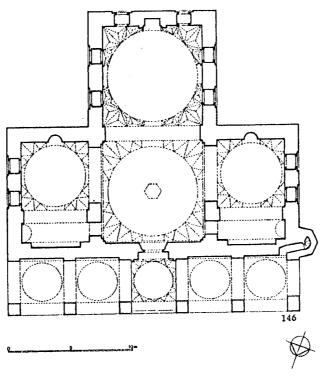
مسقط أفقي للجامع الاخضر (يشيل جامع) في بورصة) (او بروسه) . (عن : Wilde) .
